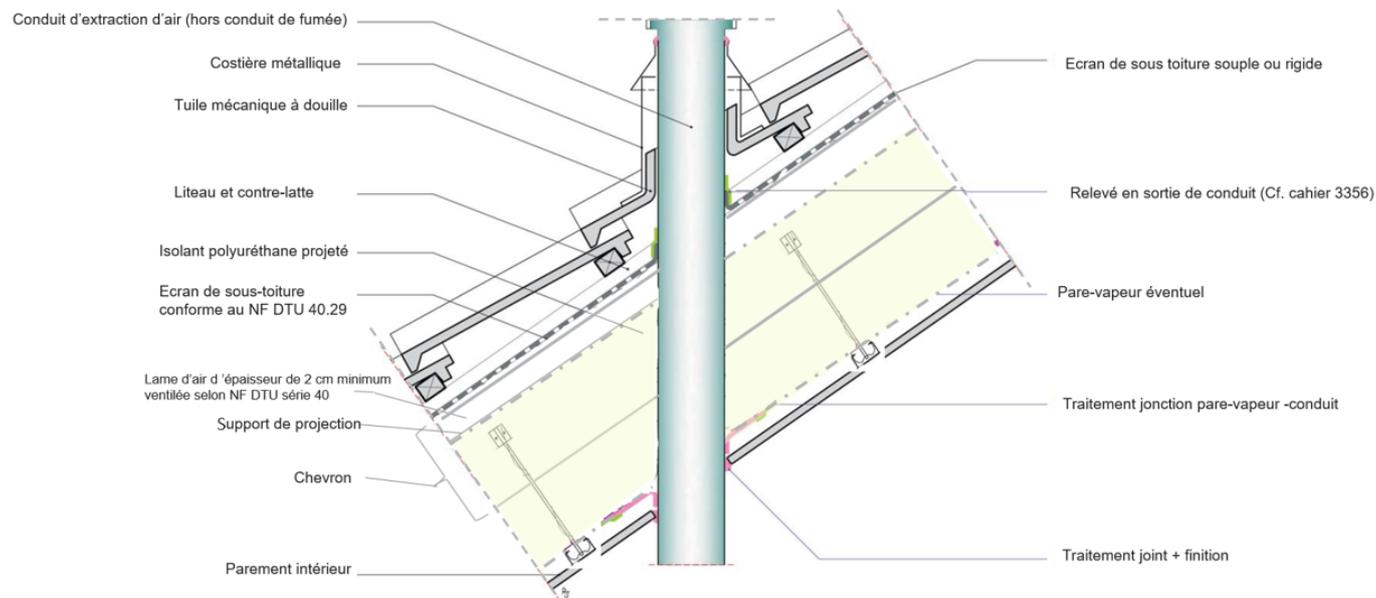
Traitement d'éléments traversants (autres que conduits de fumée)
